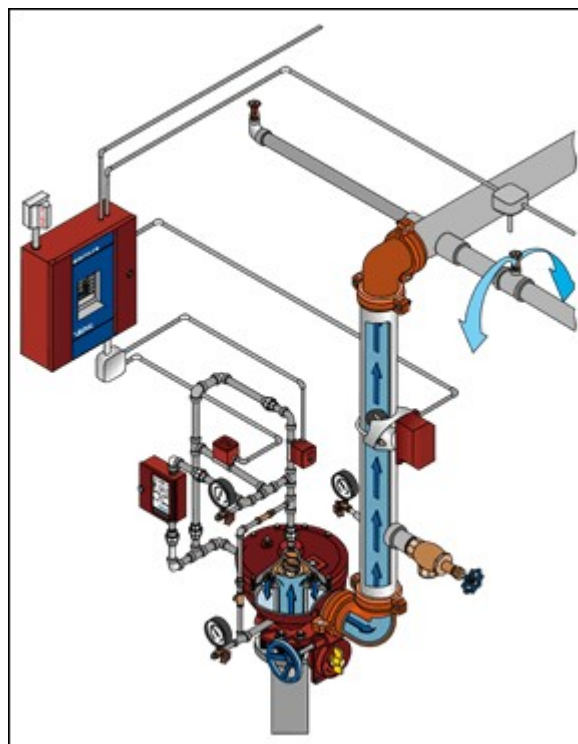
Instalación de tubería seca con rociadores abiertos
